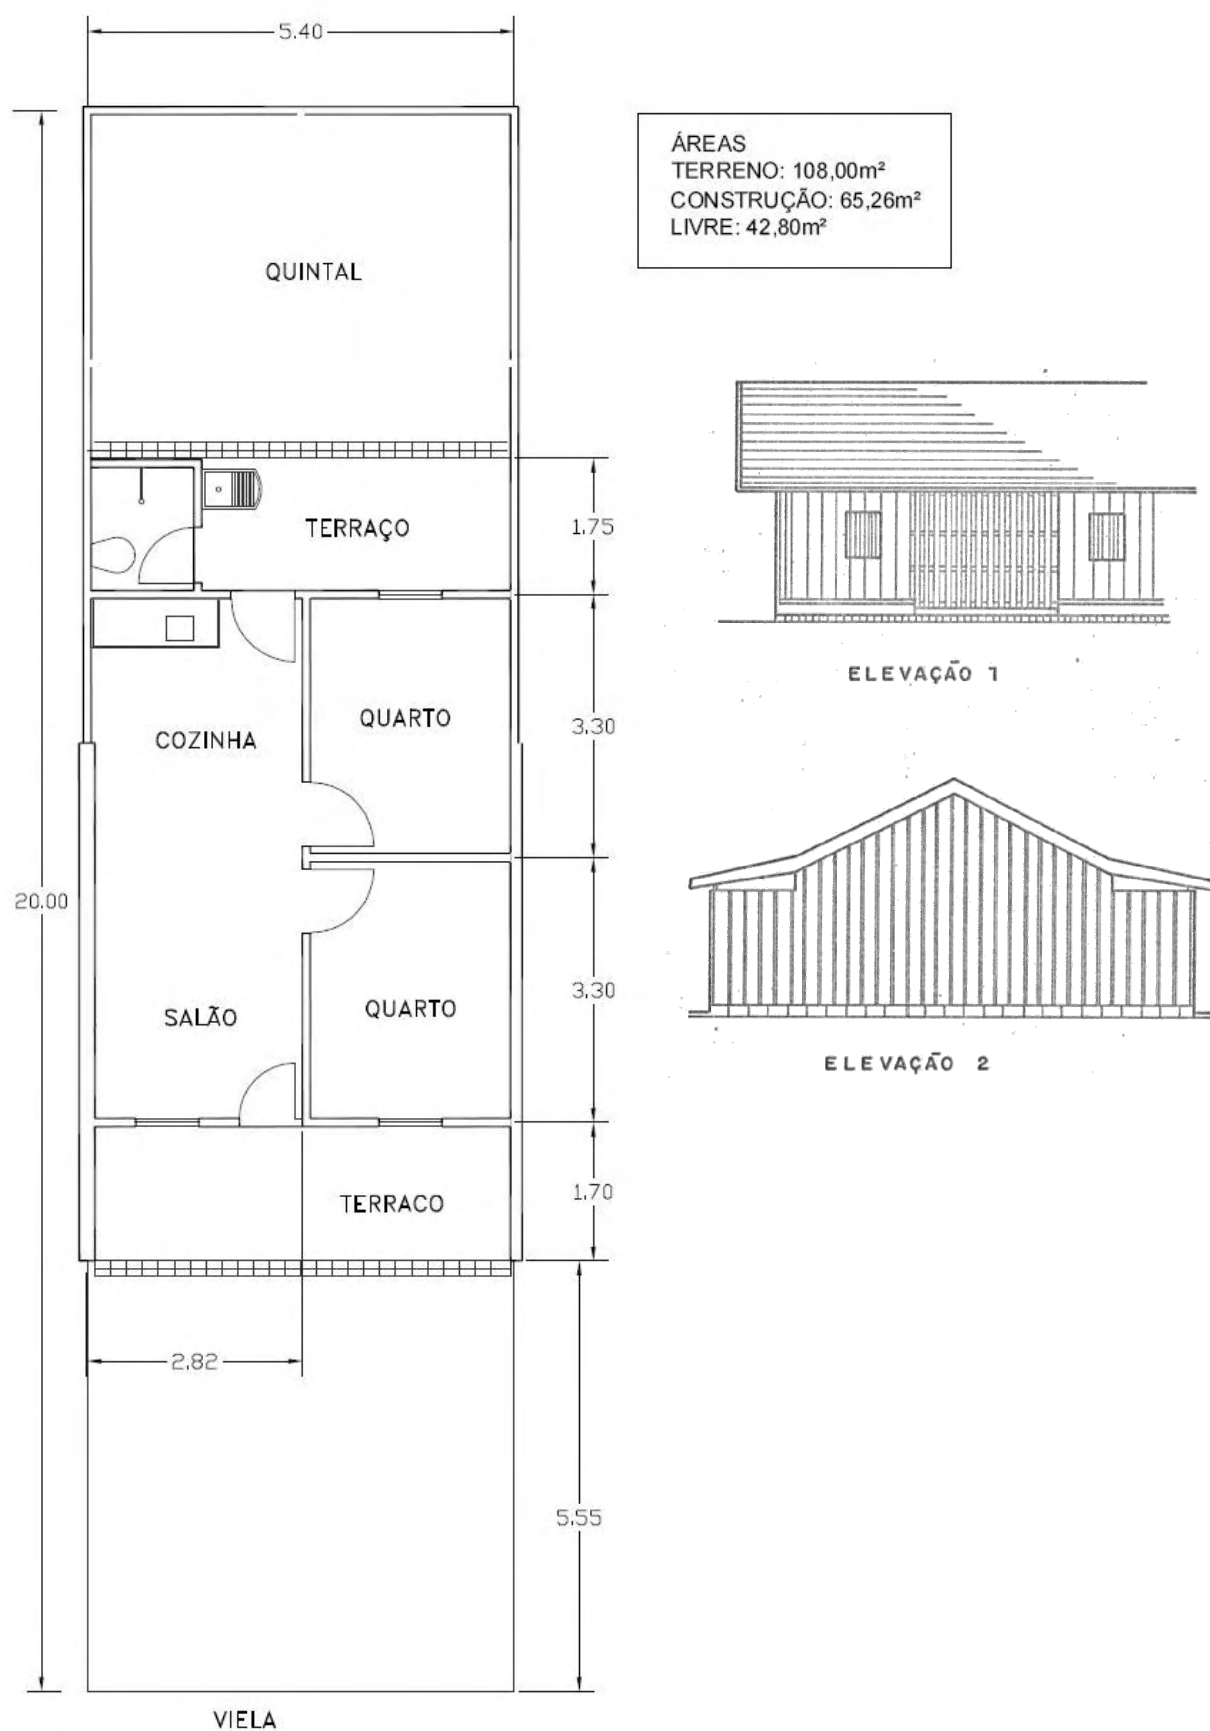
Figura E – Planta e elevação da casa tipo 2M-2Q (MANGE; KATO, 1963)
